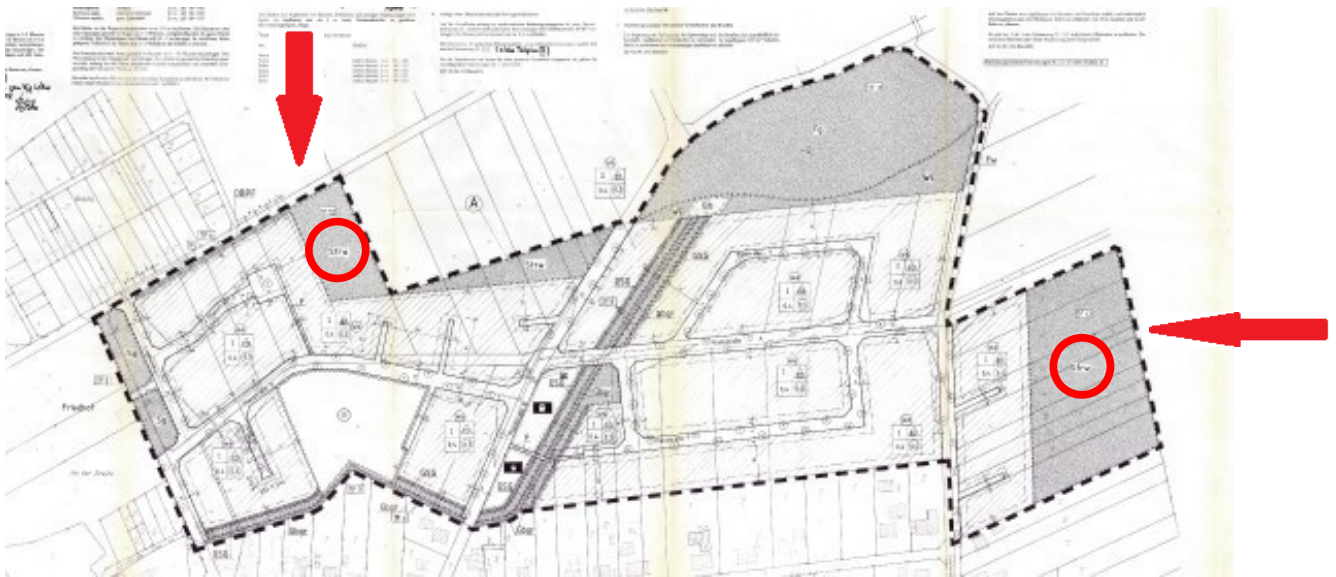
Planzeichnung zum Bebauungsplan 21 "Nördlich der Steigestraße", Gemeinde Hattorf. Quelle Geoportal Landkreis Göttingen
